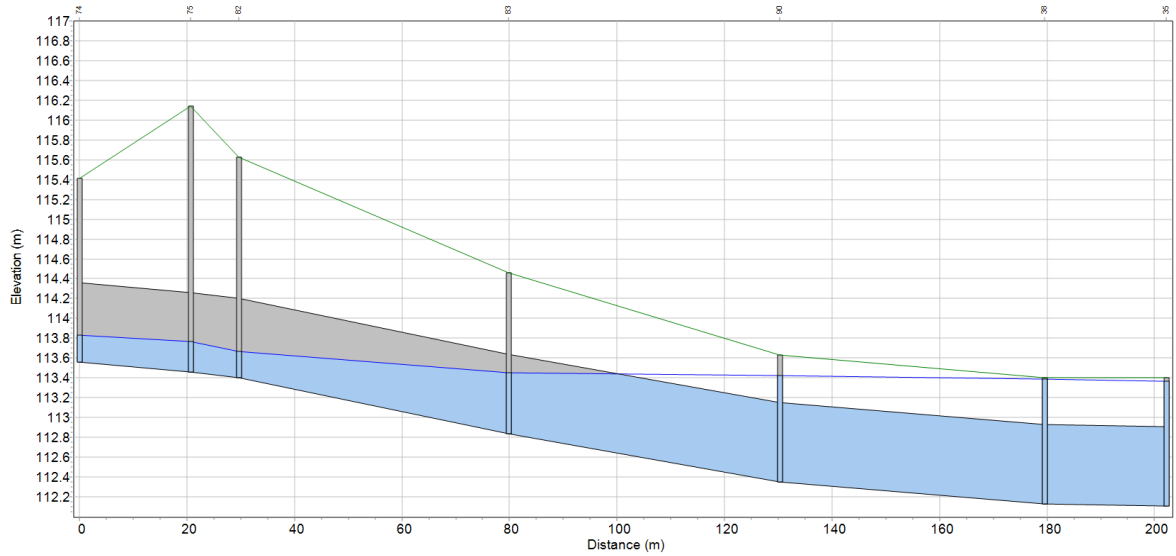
profilo disposto lungo la dorsale di collettamento posta a servizio dell’asse A, porzione ovest..
